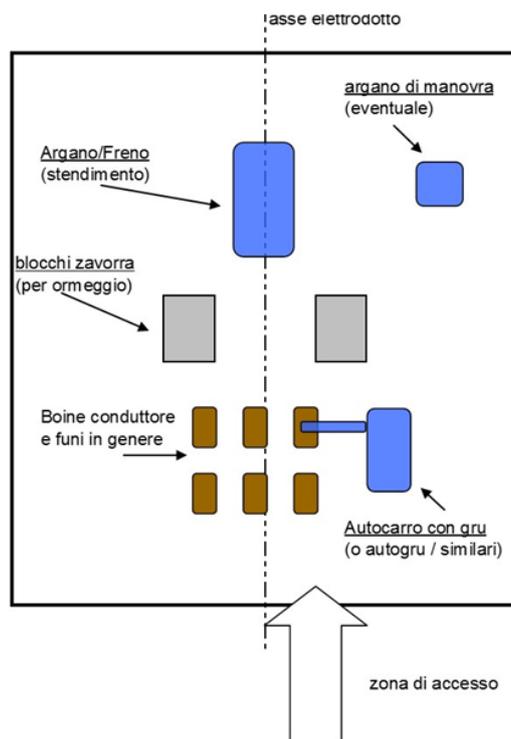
Planimetria dell'Area Sostegno (montaggio sostegno) – Planimetria dell'Area di linea - Tipologica.
